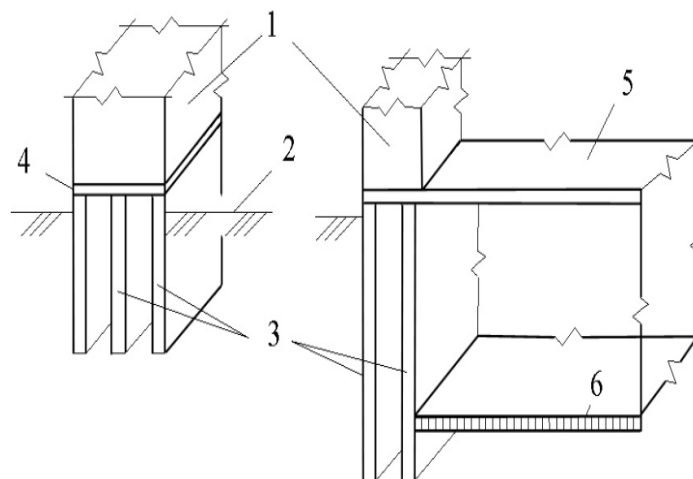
Багатощільні стрічкові фундаменти:
